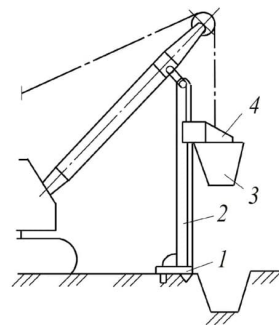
Обладнання для витрамбовування котлованів драглайном: 1 – опорна плита; 2 – напрямна штанга; 3 – штамп; 4 – каретка
